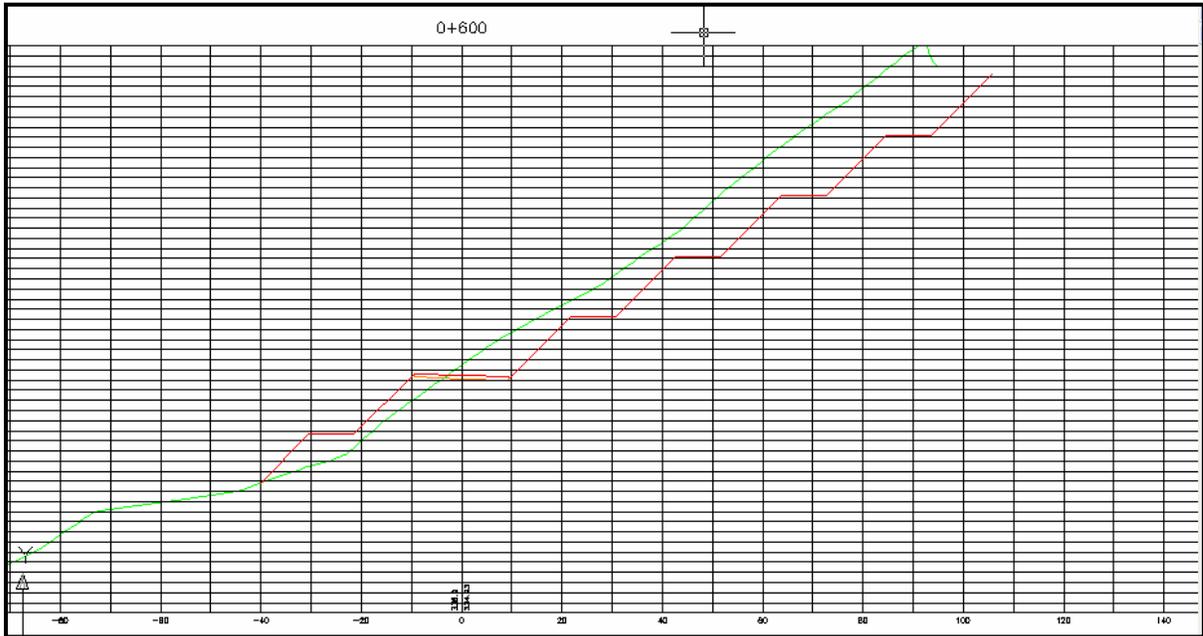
Sección transversal 0+600 del trazado D1 de la cantera de Caliza
